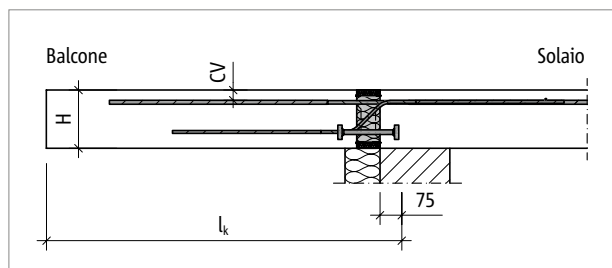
Schöck Isokorb® T tipo K-M12: schema statico
